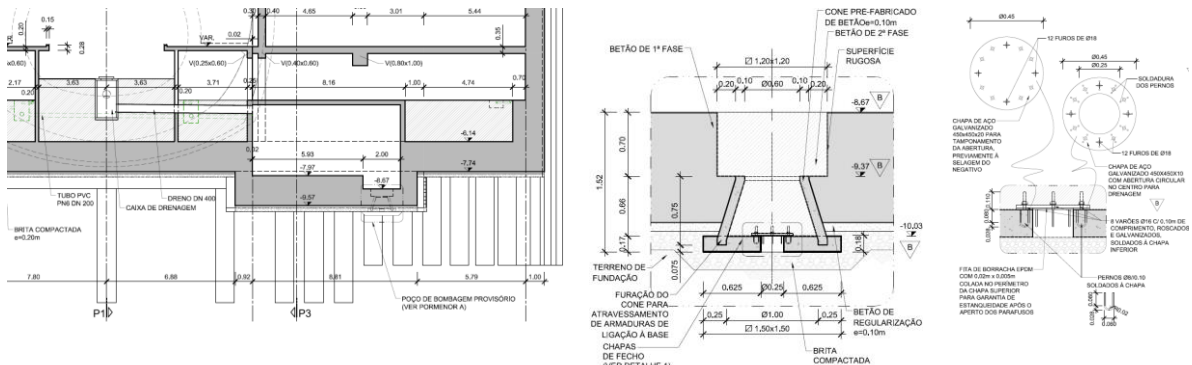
Drenagem provisória durante a fase construtiva para alívio da subpressão.
